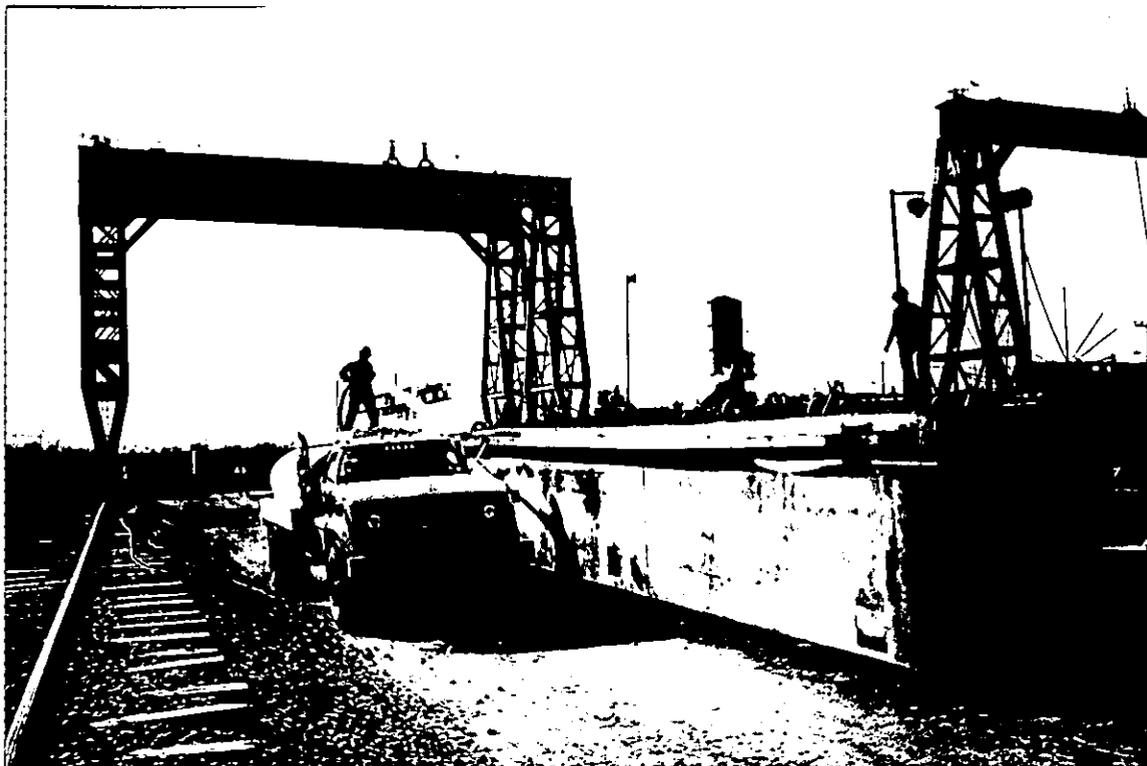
Curado del cabezal prefabricado con agua, utilizando pipas durante 7 días posteriores al desalajo del molde.
